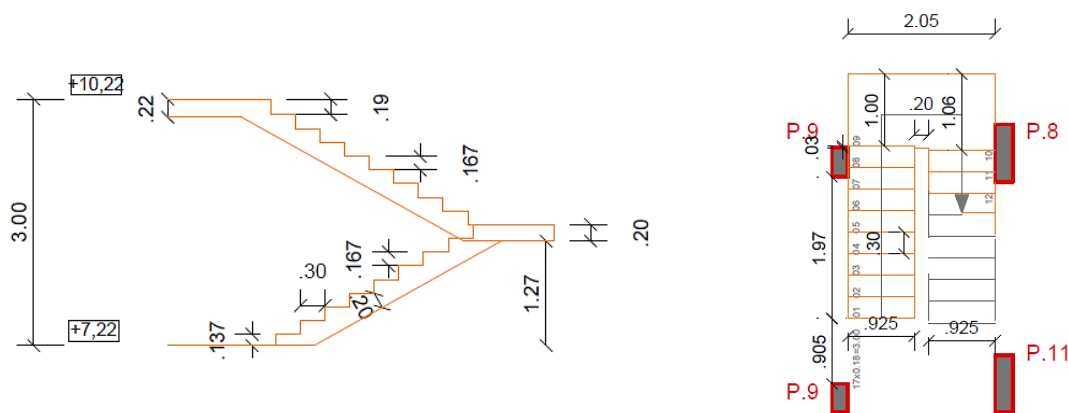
Planta e corte da escada do lote 6.6, piso -2.
